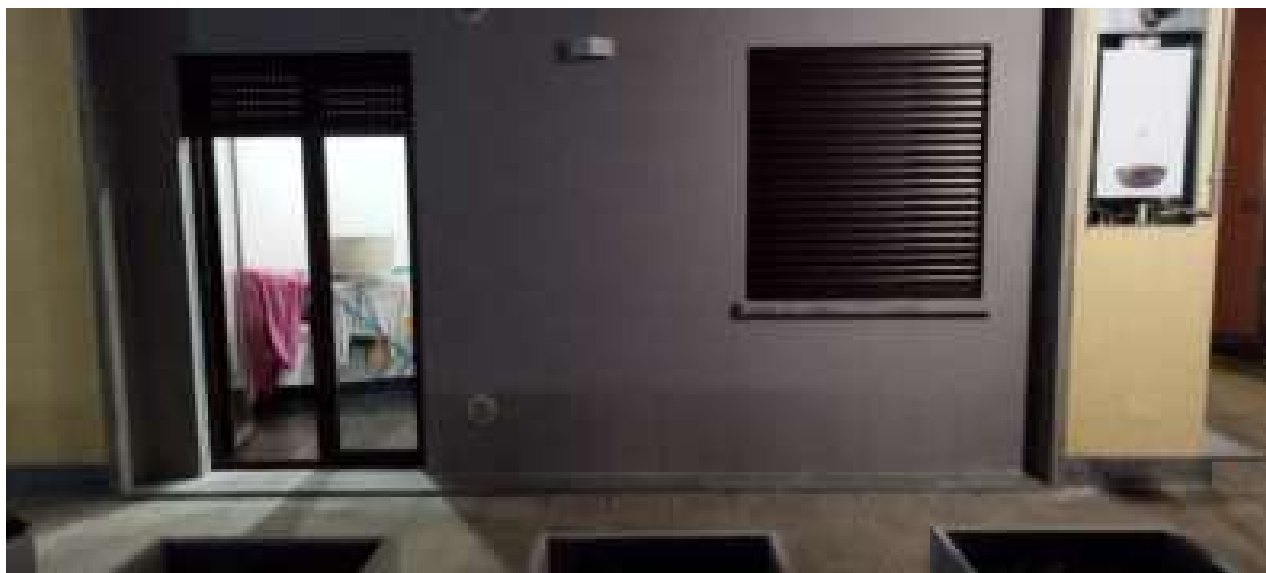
Vista Esterna, da zona di corte comune (Nord-Ovest) con particolare della caldaia.
